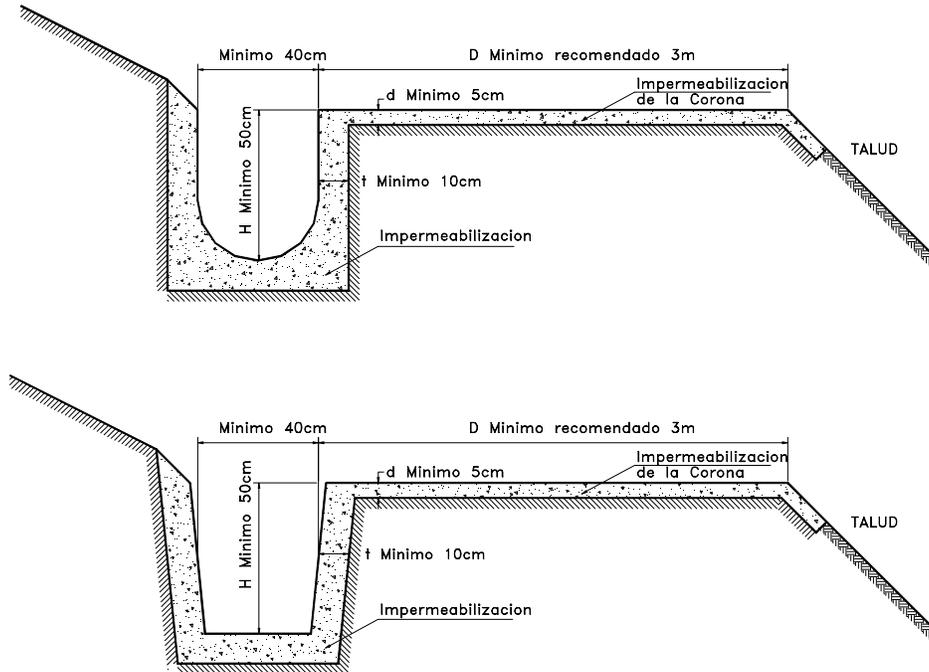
Detalle de zanjas de coronación para el control de aguas superficiales en un talud.
